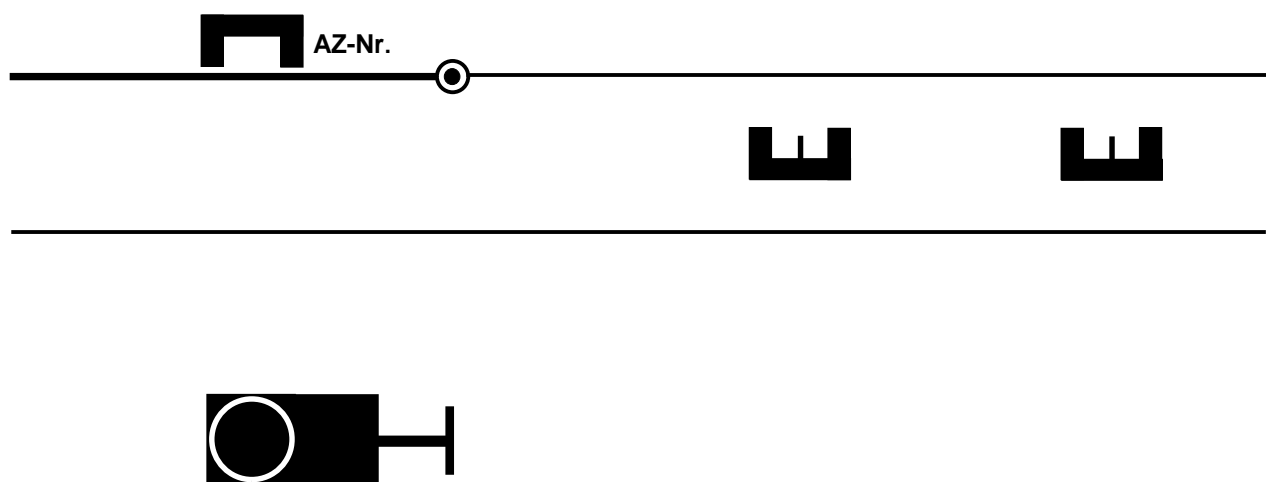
caso standard E<sub>SBB</sub> (disposizione nel piano S)
